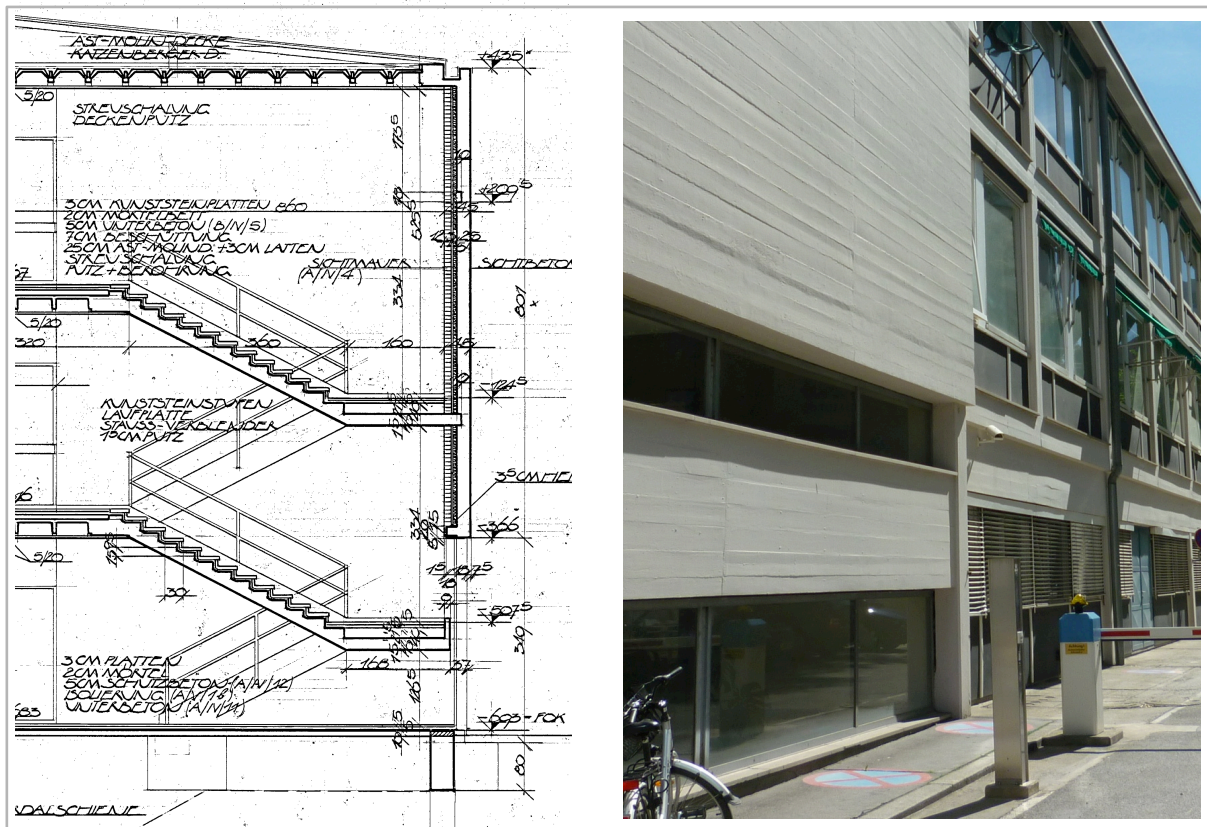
Plan- und Fotodarstellung des Fundamentbereichs des Wasserbaulabors [Plan aus TUG-Archiv]
